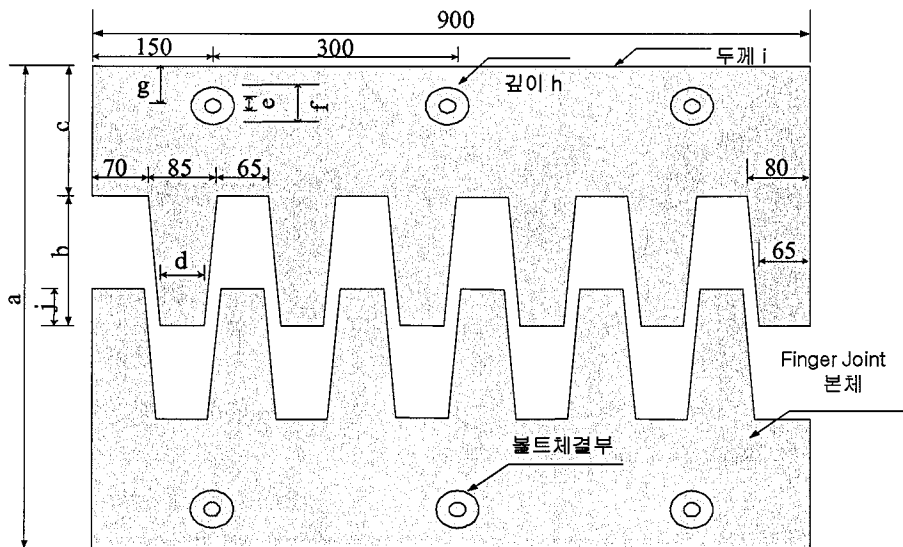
인축이음결합체의 평면도 (단위 : mm)
